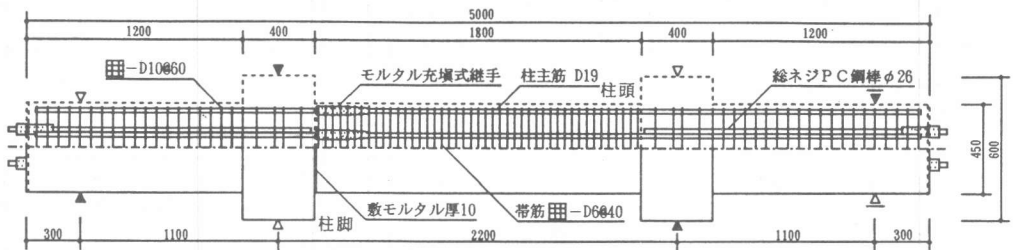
試験体の形状寸法・配筋例 (No. 2, 4)
